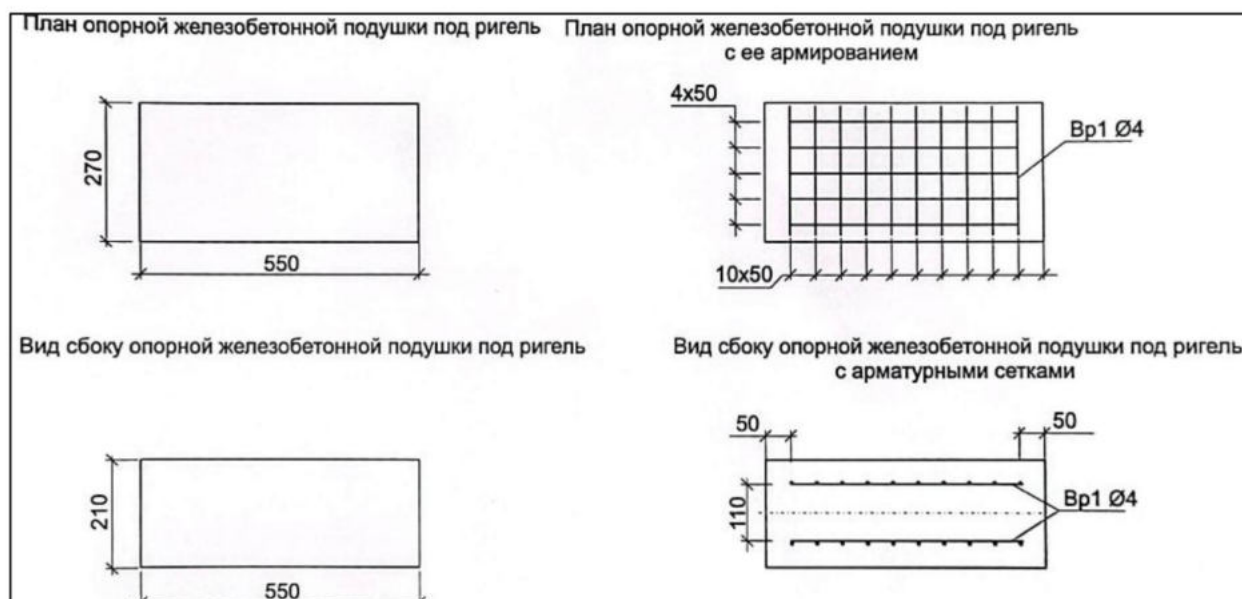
Виды опорной железобетонной подушки со схемами армирования.
